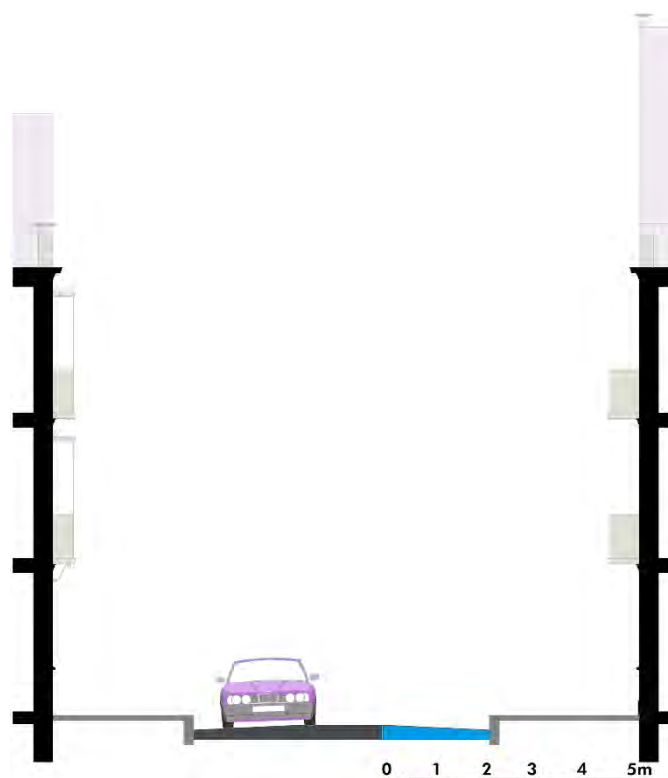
Sección tipo 1 carril + banda de aparcamiento.
